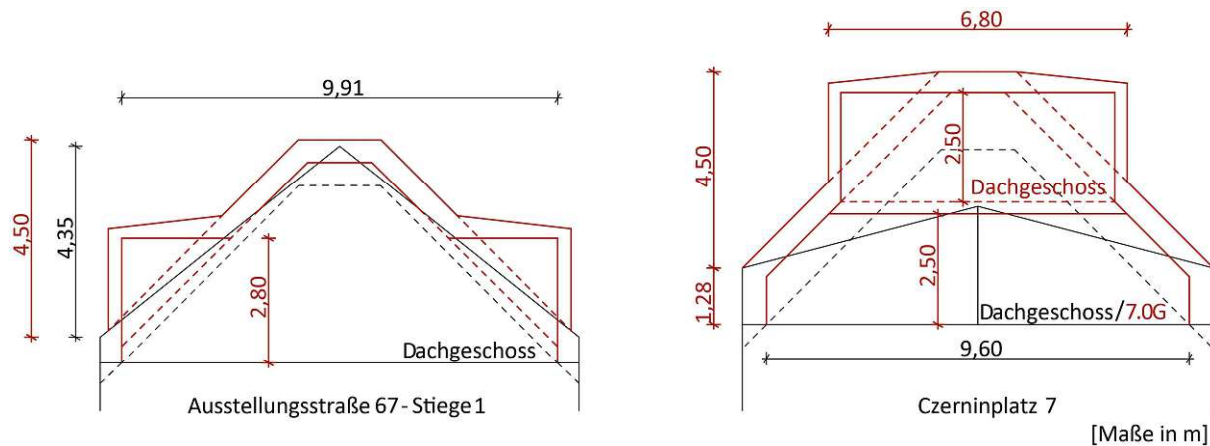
Abbildung eines Dachgeschossausbaus: Ausstellungsstraße 67 (links) und einer Aufstockung: Czerninplatz 7 (rechts) nach [58]
